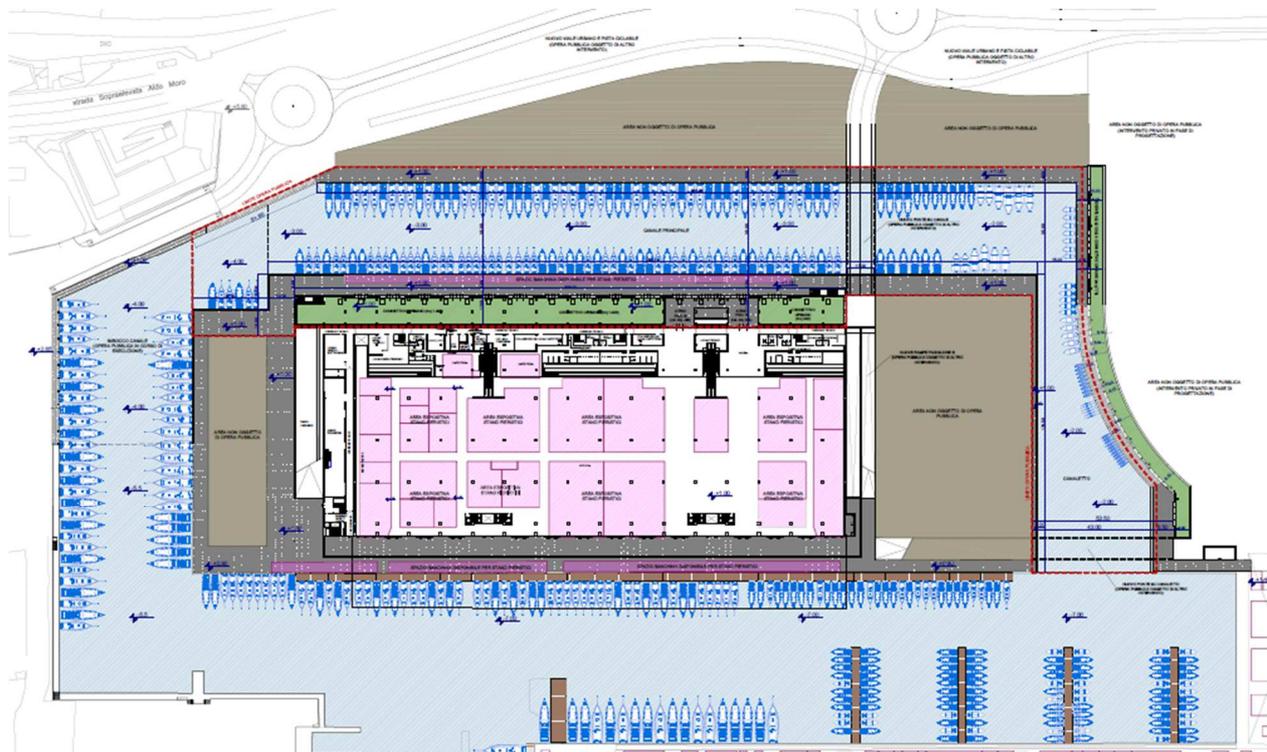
Planimetria generale di inquadramento progetto a quota banchina – Stralcio elaborato Ar-T03
